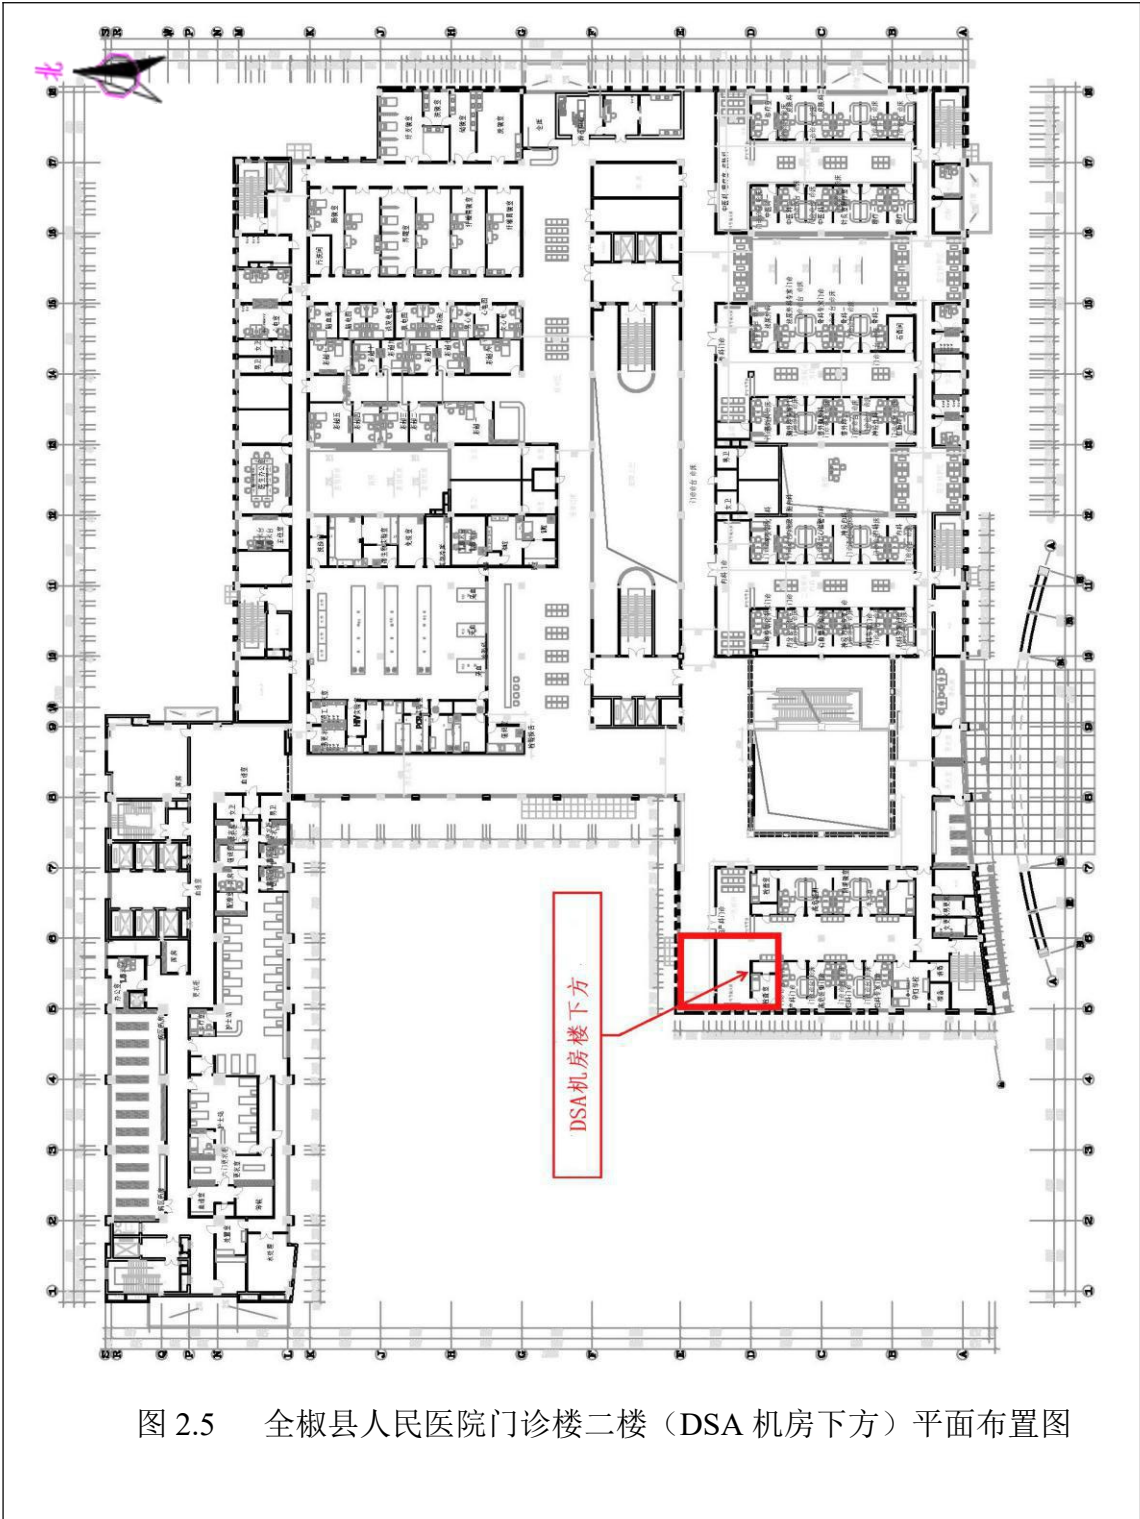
全椒县人民医院门诊楼二楼（DSA 机房下方）平面布置图
